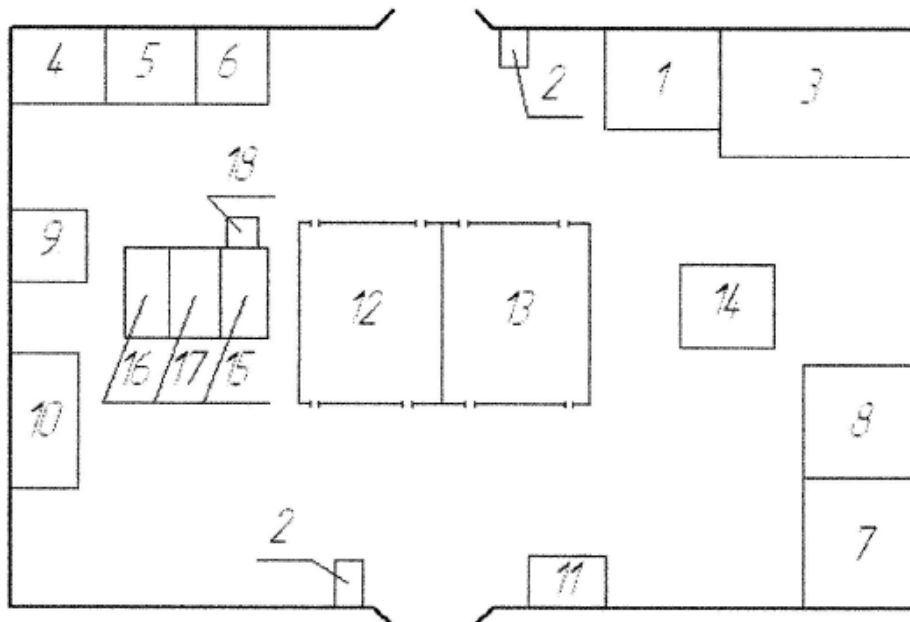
Генеральный план производственной зоны предприятия
